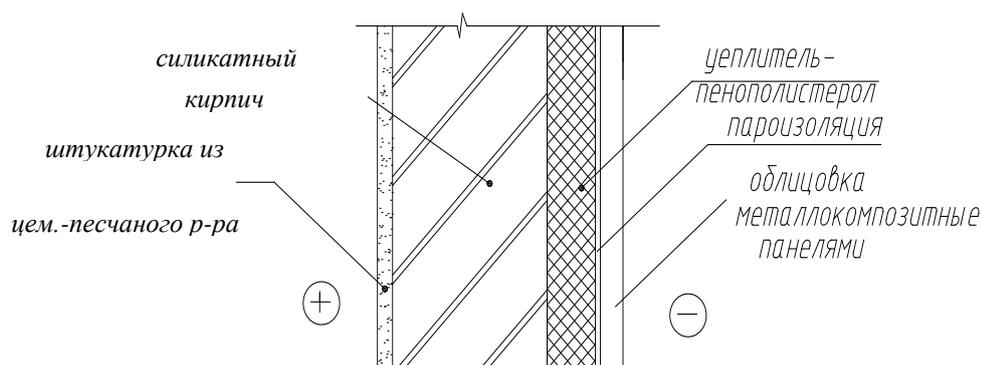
К теплотехническому расчету наружной стены.
